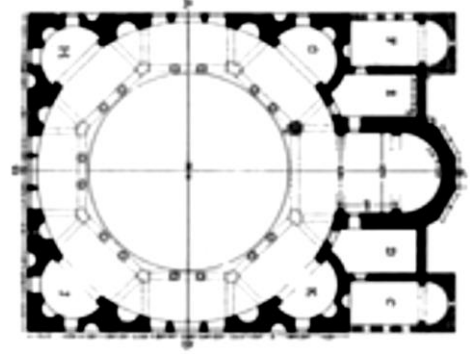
المسقط الأفقي لجامع نيشانجي محمد باشا:
